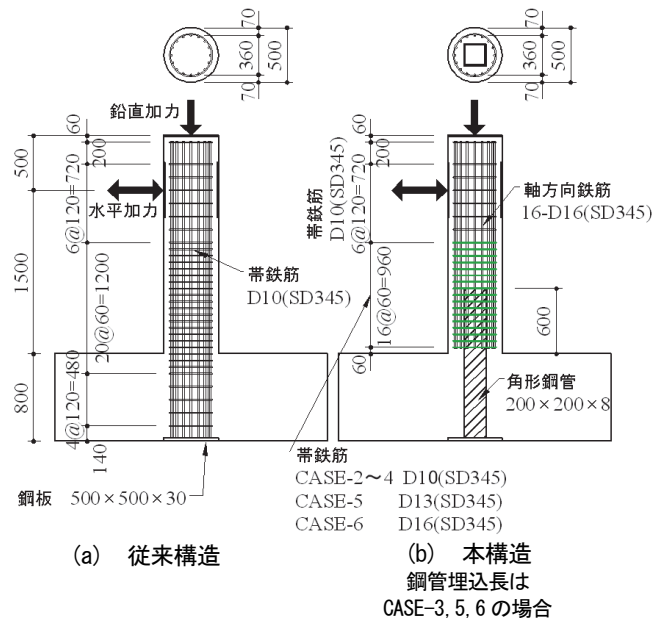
試験体配筋図および鋼管埋込長 (単位 mm)
